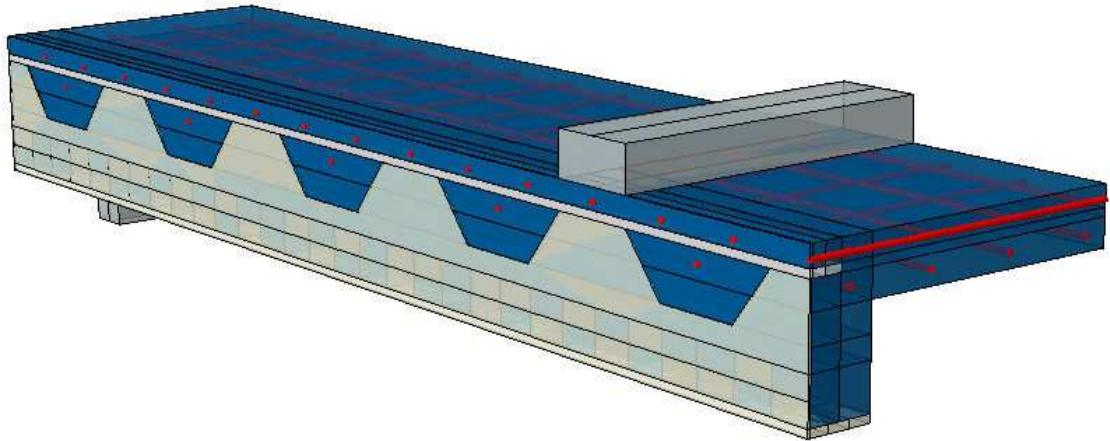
Modelo geométrico da armadura da laje para o modelo C1P15.
